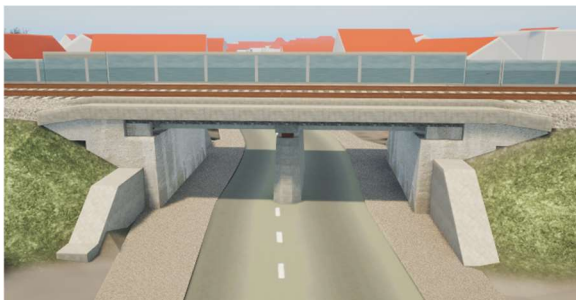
EÜ Eisenbahnstraße (Bestand)
